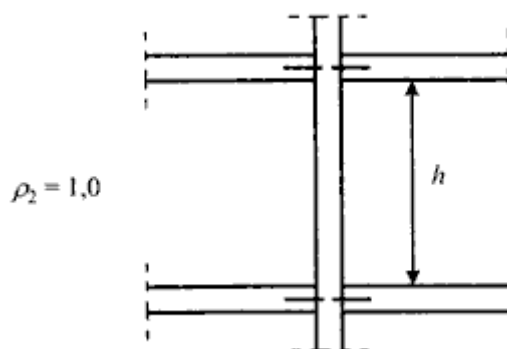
Отсутствие жесткого защемления (от поворота) перекрытиями и конструкциями крыши
